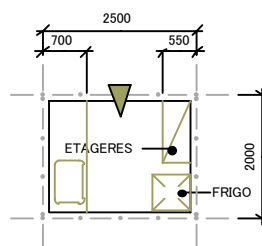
Plan planimétrique du local d'approvisionnement en eau chaude
